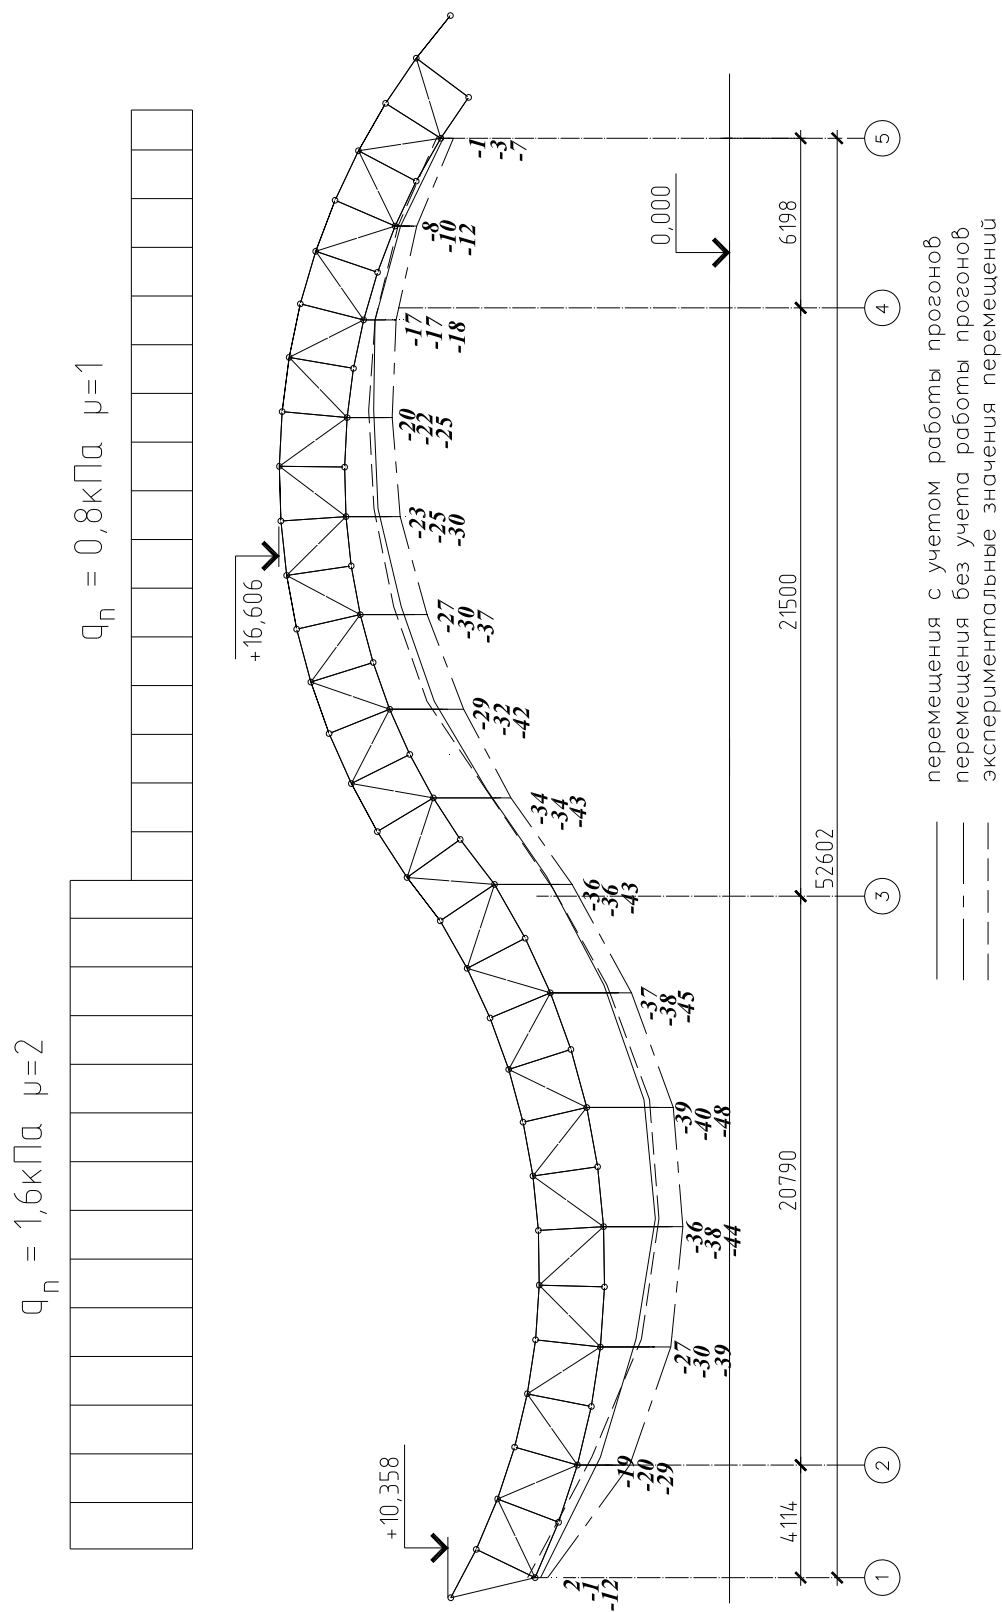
Схема нагружения покрытия снеговой нагрузкой и эпюры вертикальных перемещений узлов нижней поясной сетки по оси В при нагружении покрытия испытательной нагрузкой
